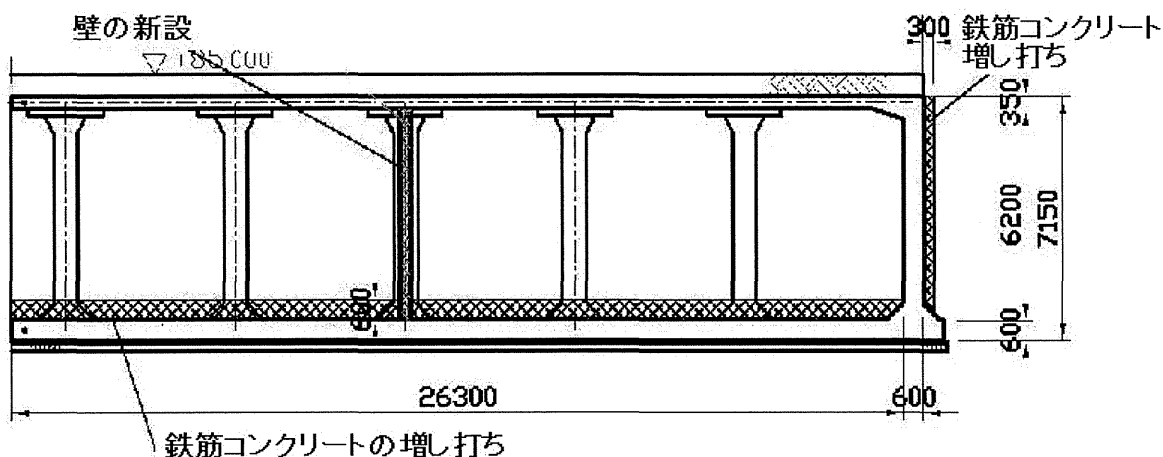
鉄筋コンクリート増打ち工法の施工例
